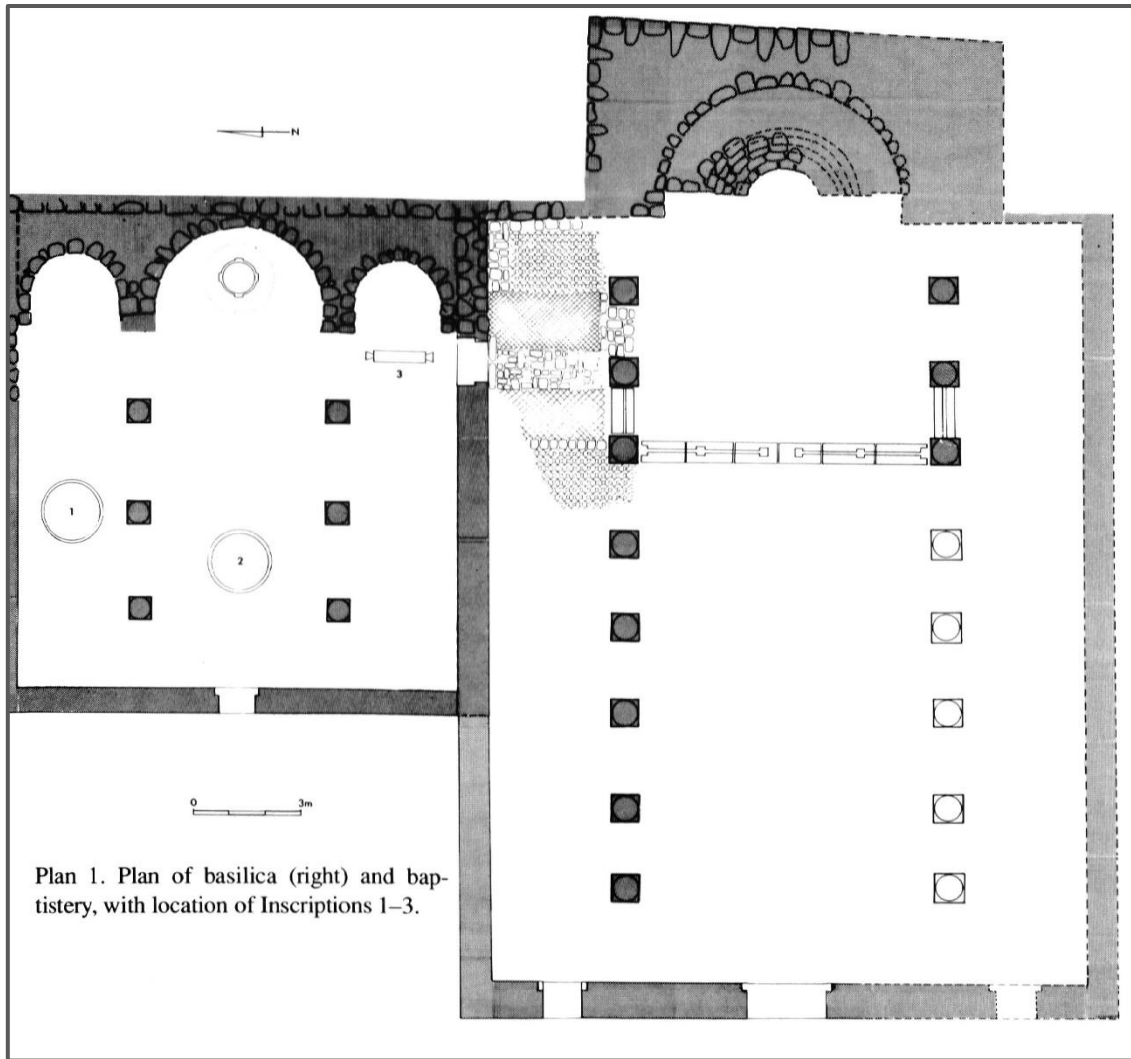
Sussita. Pianta del complesso (Epstein, Tsaferis 1991, pianta 1).
